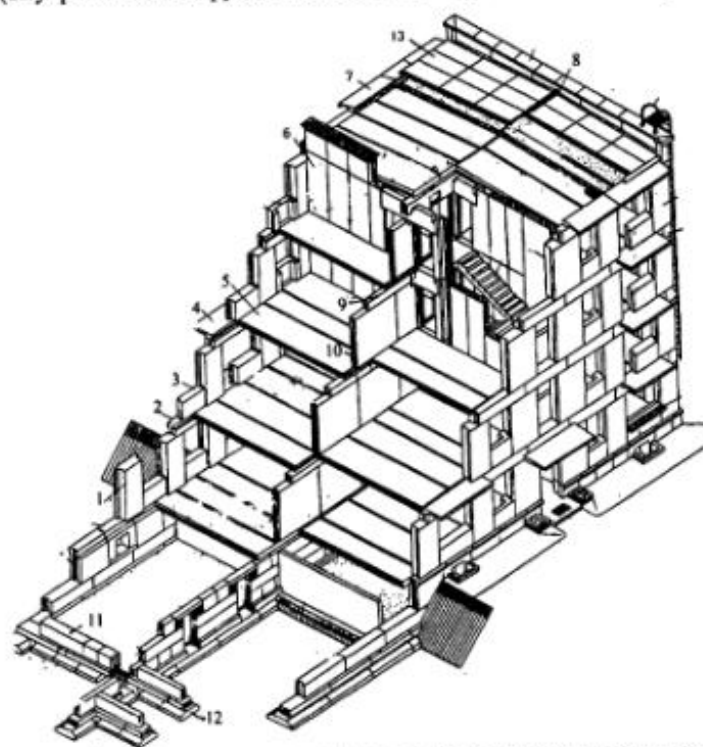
Схема конструкций бескаркасного крупноблочного дома продольно-стеновой системы: 1 - блок наружной стены простеночный, 2 - то же, перемычный, 3 - то же, подоконный, 4 - балконная плита, 5 - железобетонный преднапряженный многопустотный настил перекрытия, 6 - вентиляционный блок, 7 - карнизная плита, 8 - парапетная плита, 9 - блок внутренней стены поясной, 10 - то же, простеночный, 11 - бетонный блок стены подвала, 12 - железобетонная фундаментная подушка, 13 - подкровельная плита
